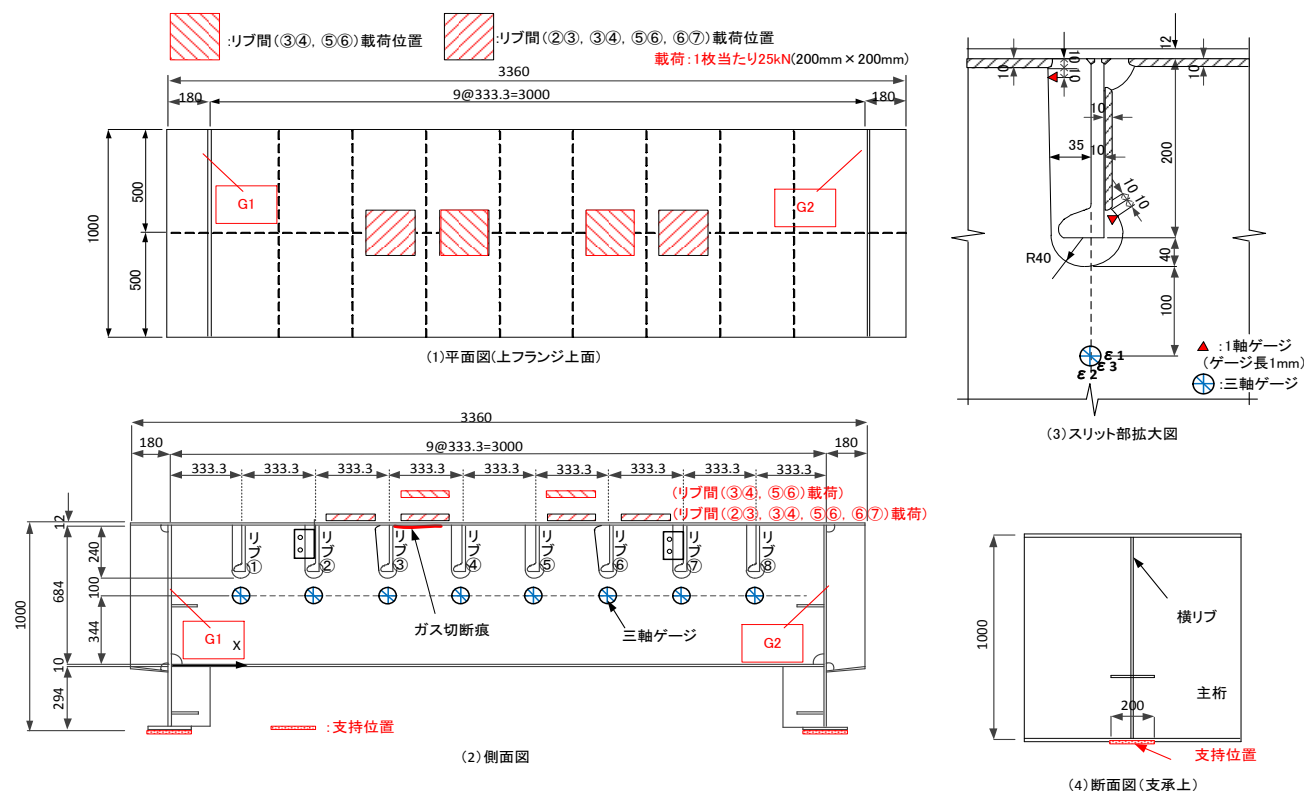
No.2 試験体の形状と寸法および荷重位置とひずみゲージ貼付位置
